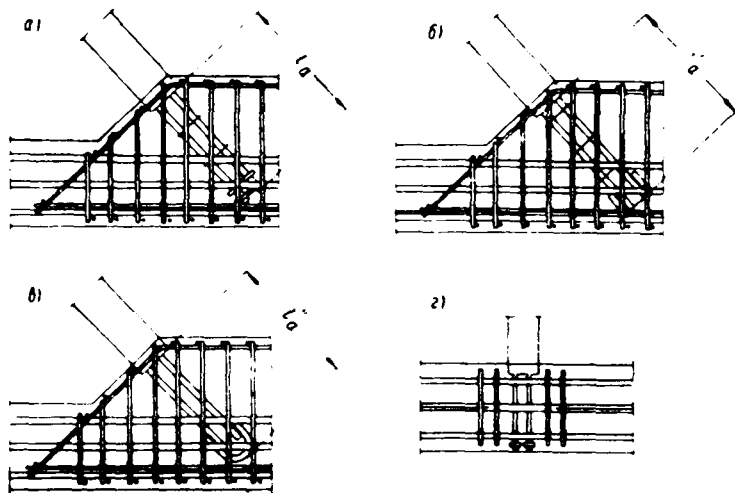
Анкеровка арматуры растянутых раскосов и стоек ферм
